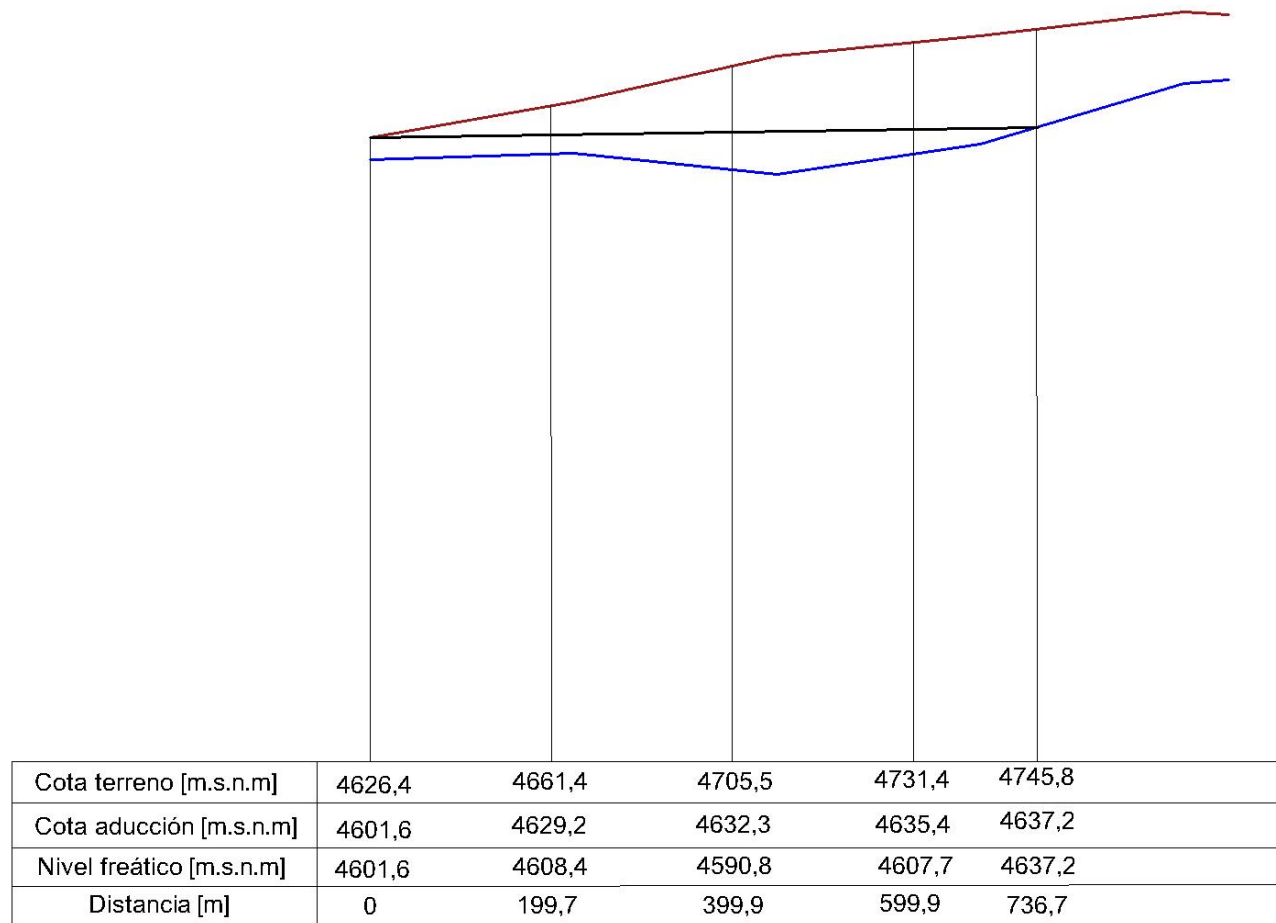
Perfil longitudinal de aducción en Quebrada 15.
